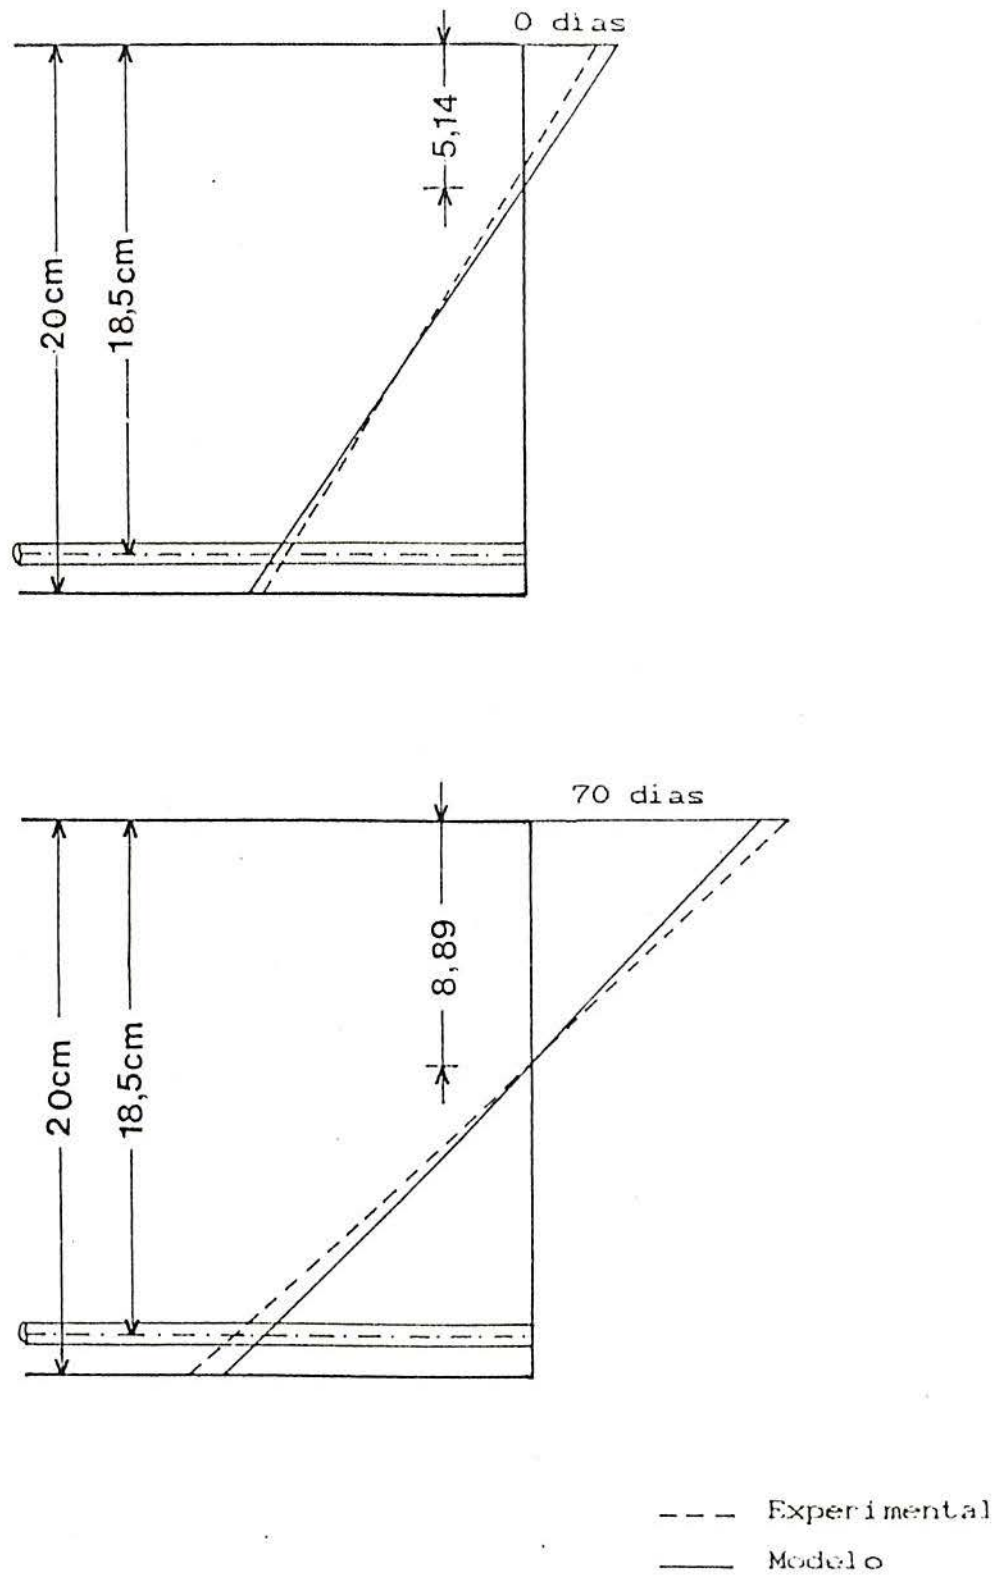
Deformações na seção central das vigas para o carregamento instantâneo e de longa duração.
